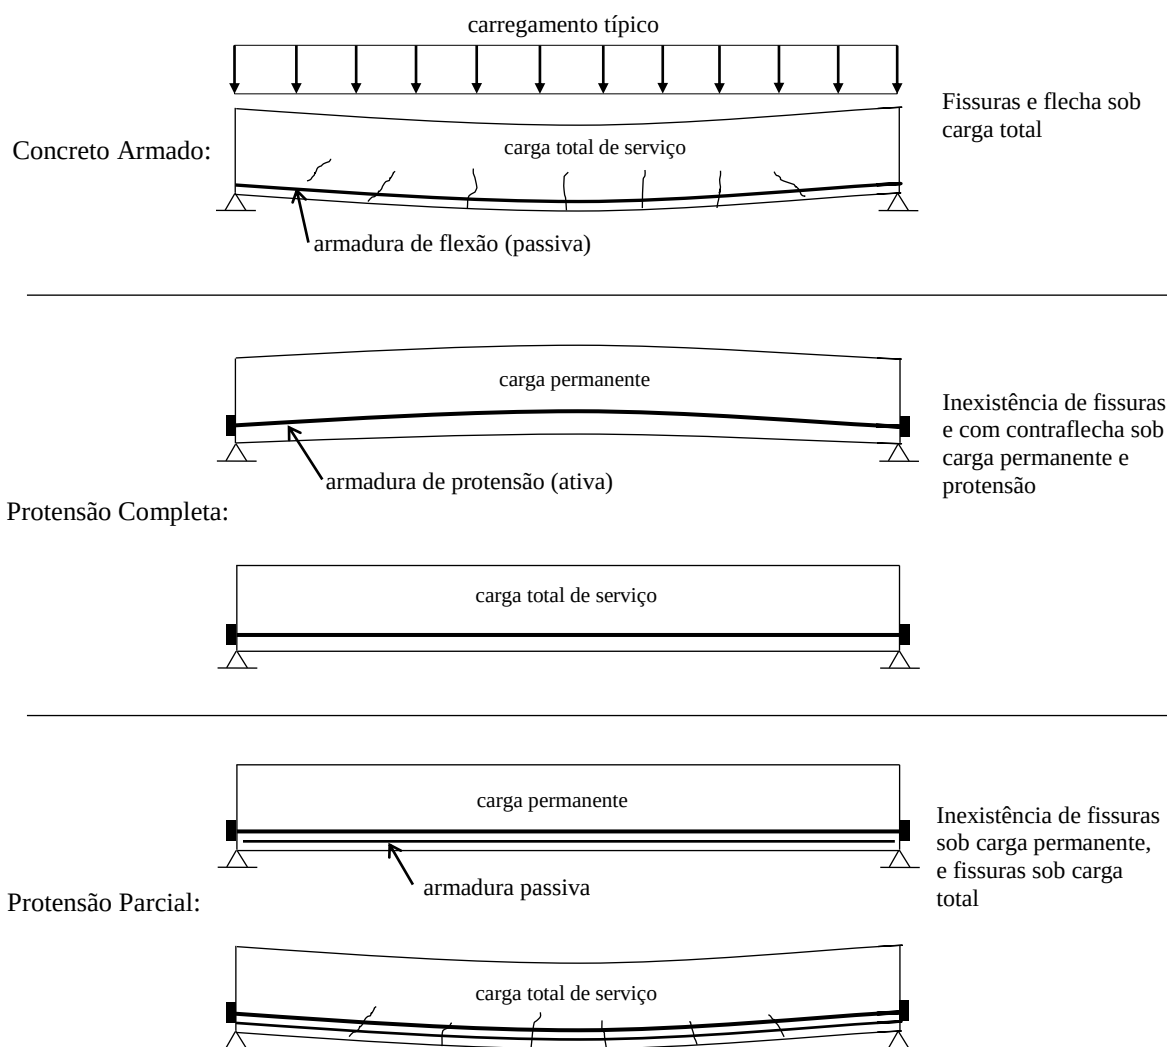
Comportamento de viga de Concreto Armado e de Concreto Protendido com protensão completa e parcial.^[2]
